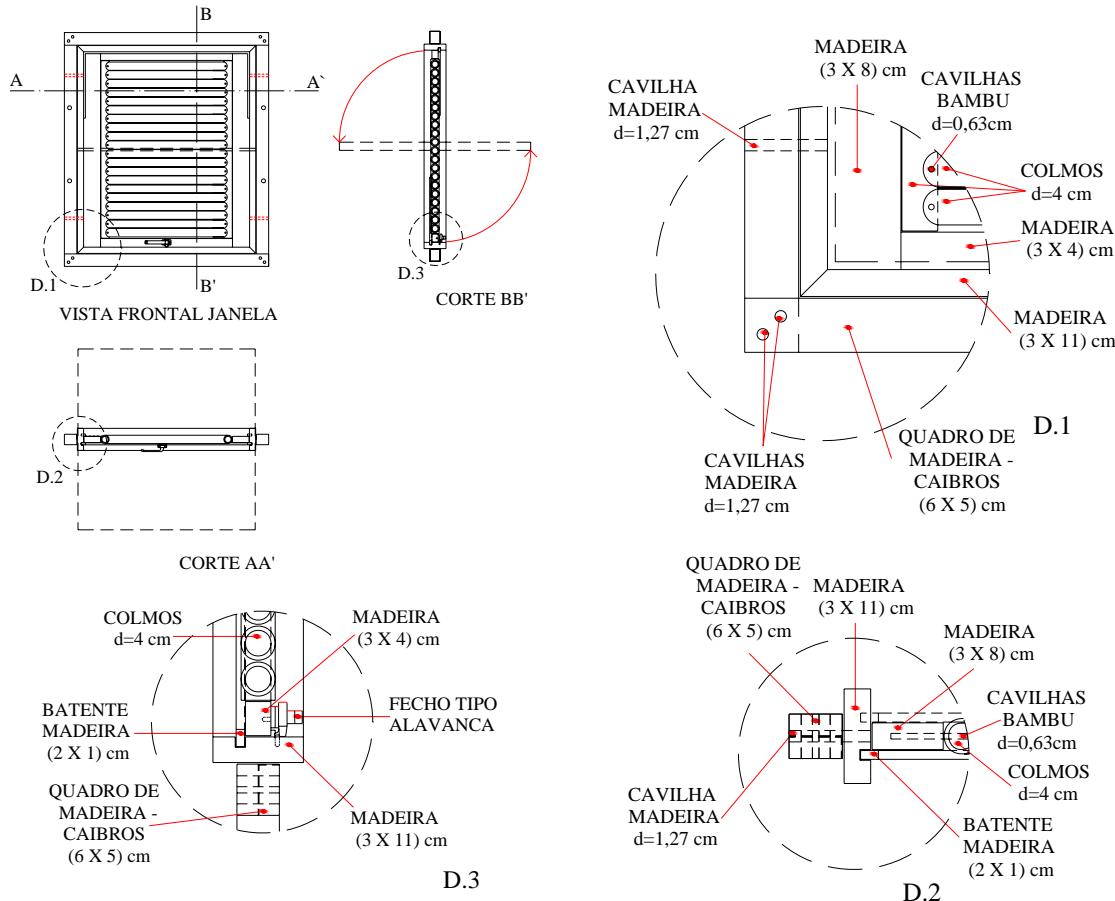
Concepção da janela - Modelo ES01 (vista frontal, cortes e detalhes).
